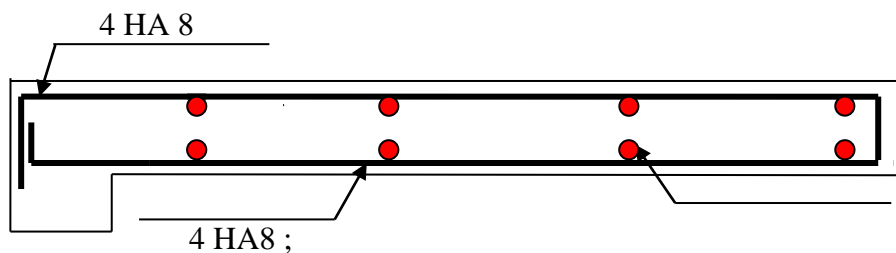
Schéma de ferrailage de la dalle pleine sur deux appuis
